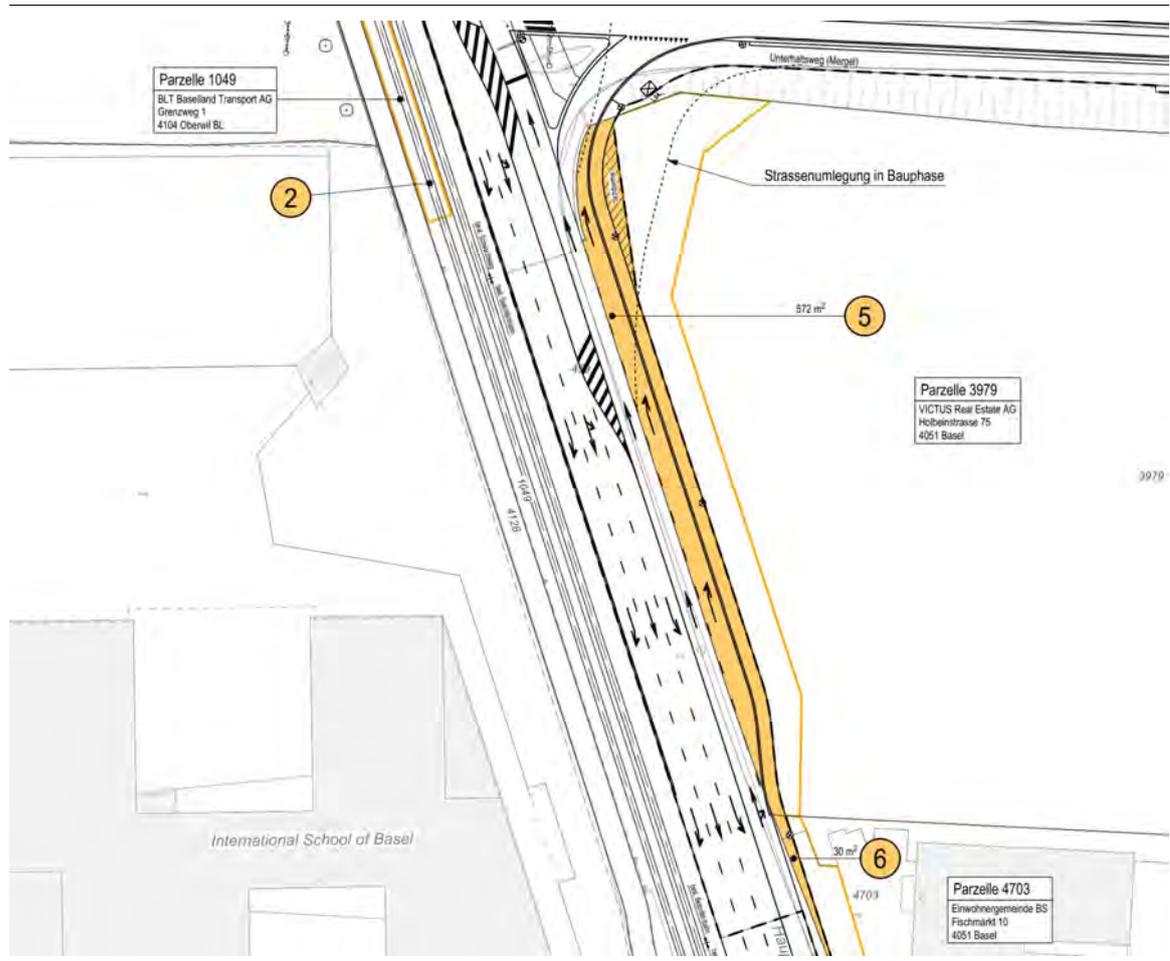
Ausschnitt Landerwerbsplan Bauprojekt "Zubringer Pfeffingerring"
